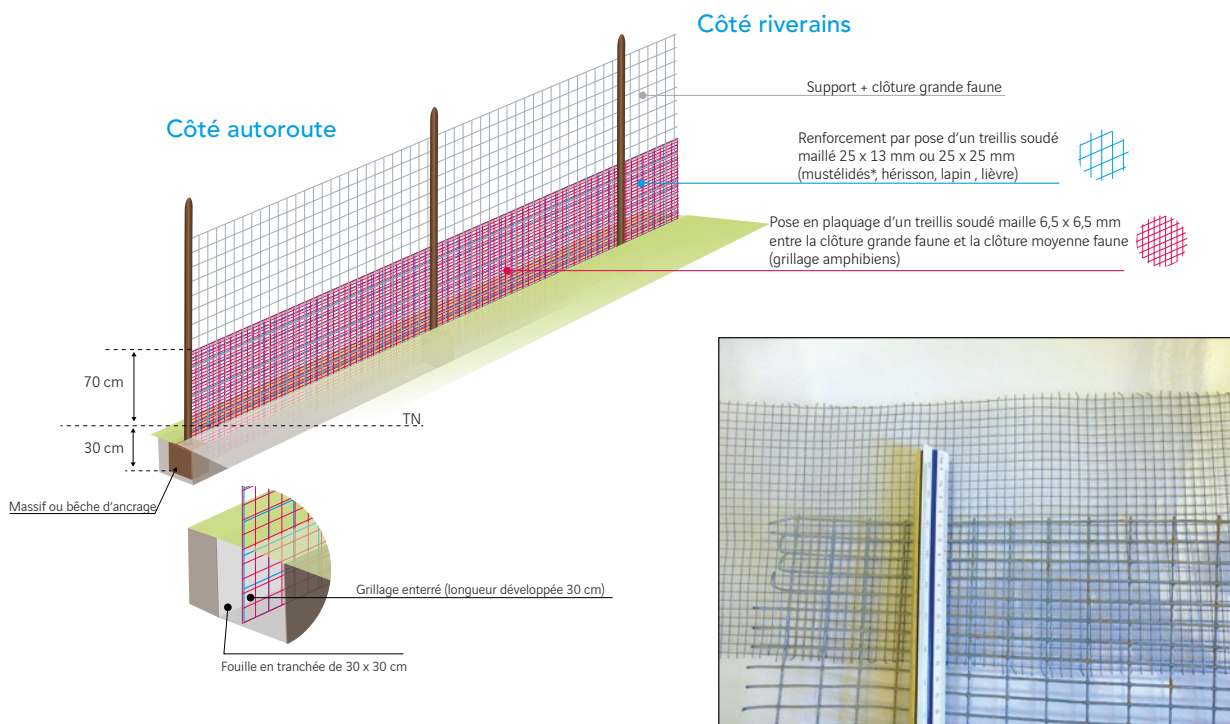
Mailles de 6,5x6,5 mm et de 25x13 mm (gauche), schéma de principe du renforcement (droite).
